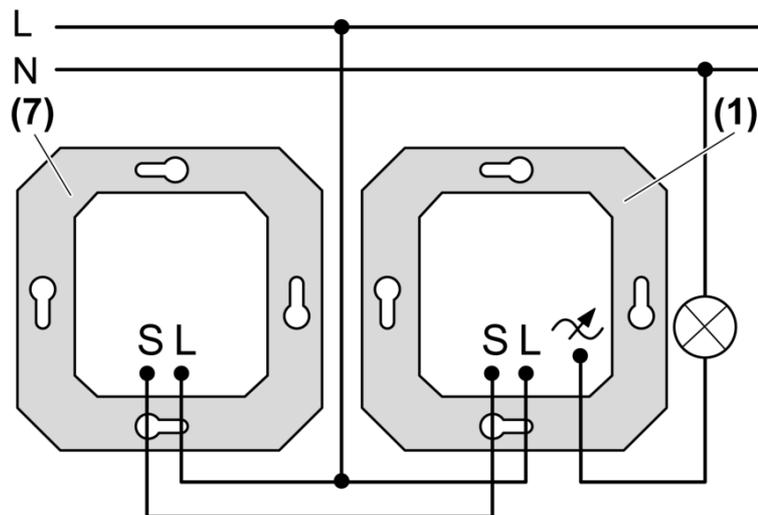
Anschlussplan Dimmer mit Nebenstelle
